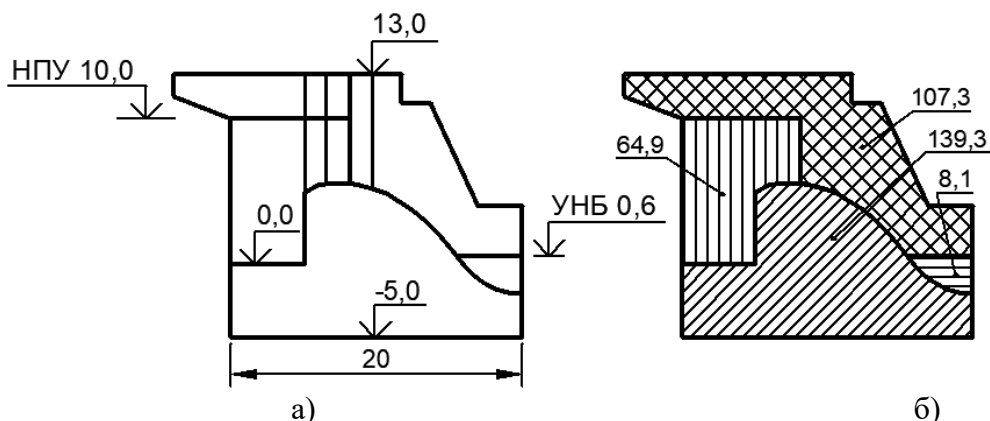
Исходные данные к расчёту нагрузок на бетонную водосливную плотину
